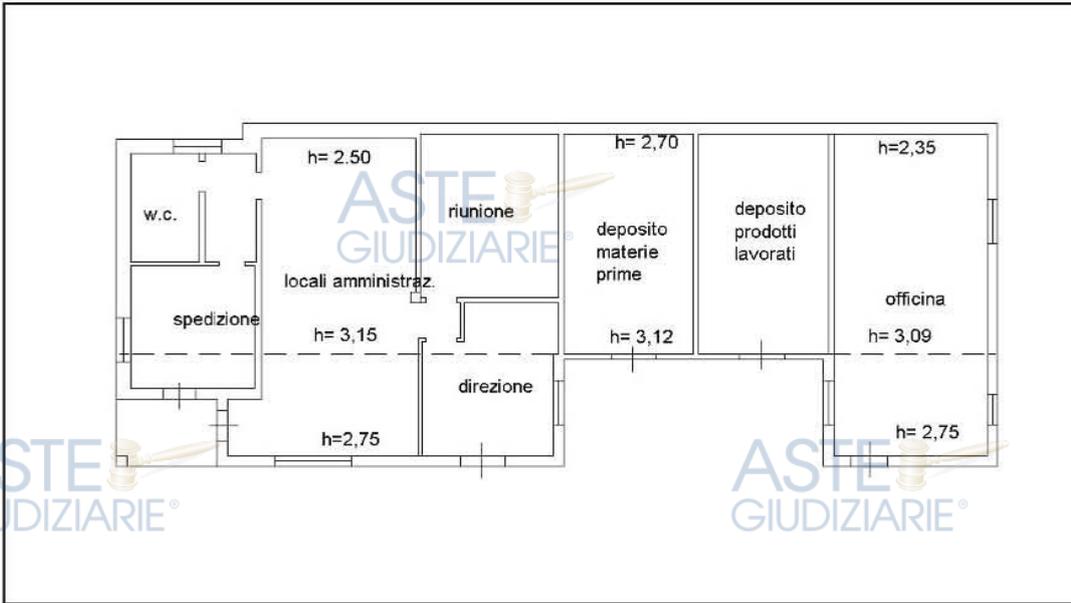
Lotto 3 – Stralcio della planimetria catastale uffici e deposito, piano terra sub. 9 (non legittimati).
